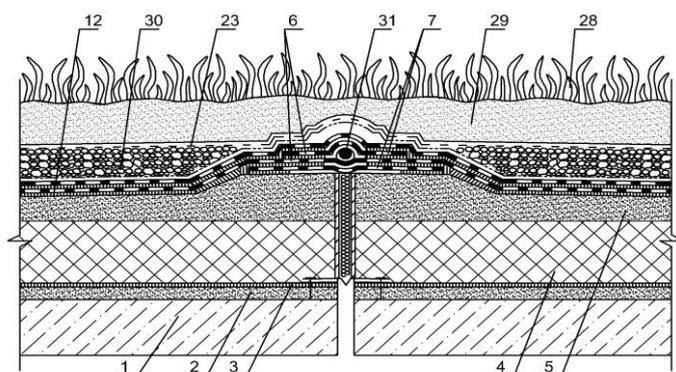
Конструкция традиционной эксплуатируемой кровли.
